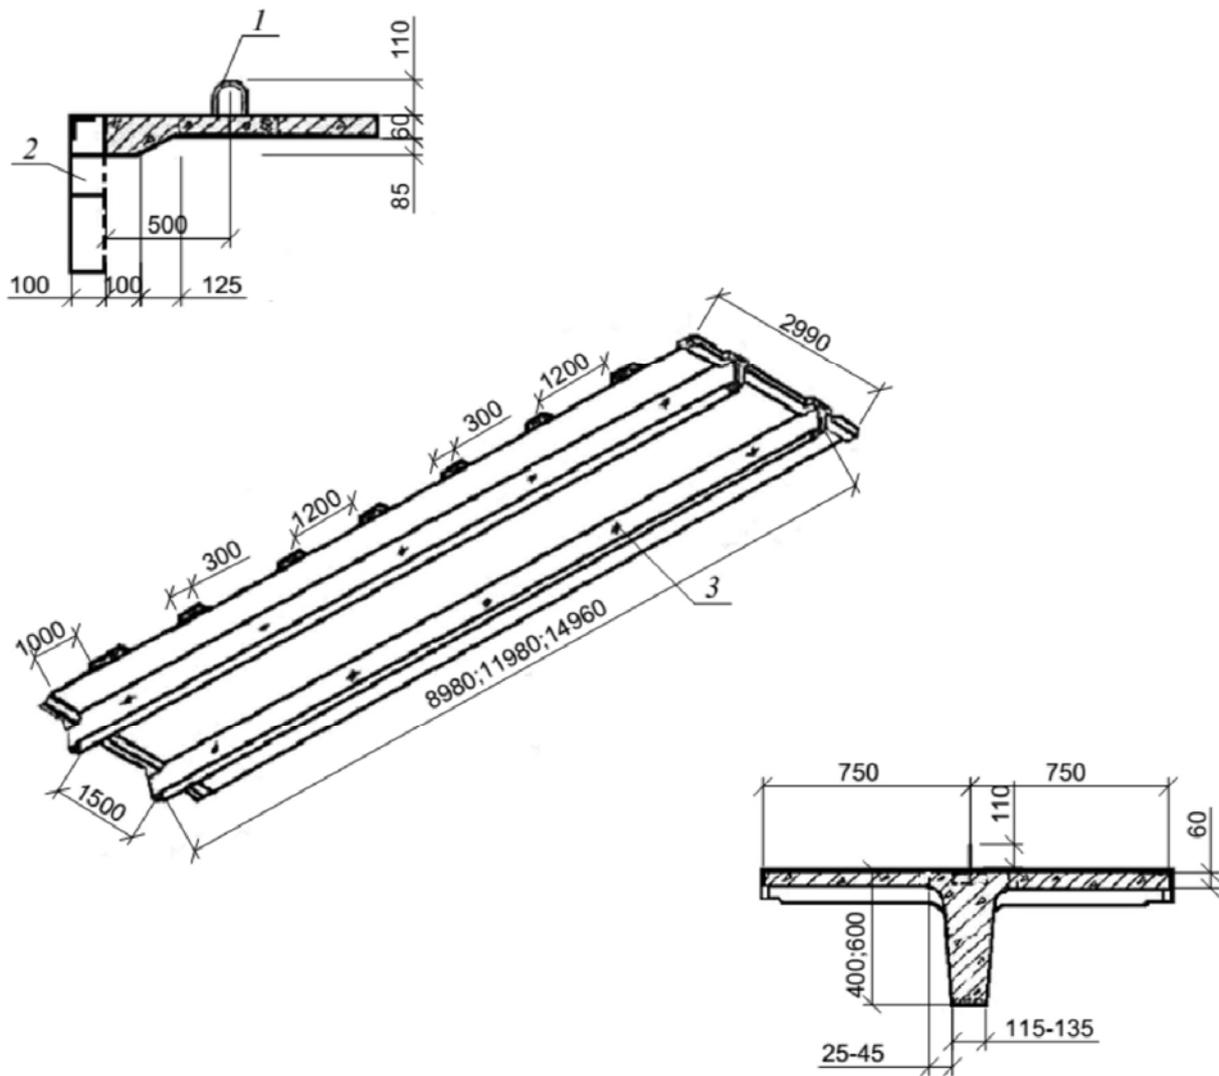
Железобетонные ребристые плиты ТТ- и Т-образного сечения для шага стен до 15 м (серия 1.242-1): 1 — строповочные петли; 2 — ограничение плит, опирающихся на нижнюю полку ригеля; 3 — отверстия диаметром 38 мм через 2400 мм для подвески электроарматуры
